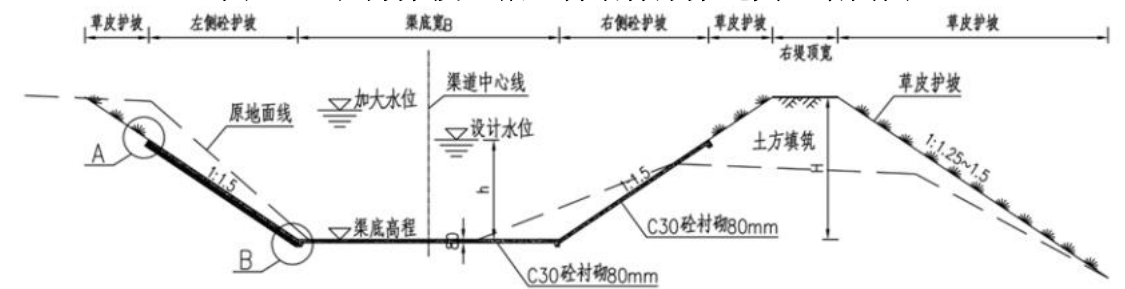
半挖填渠段混凝土衬砌梯形渠道典型断面图
